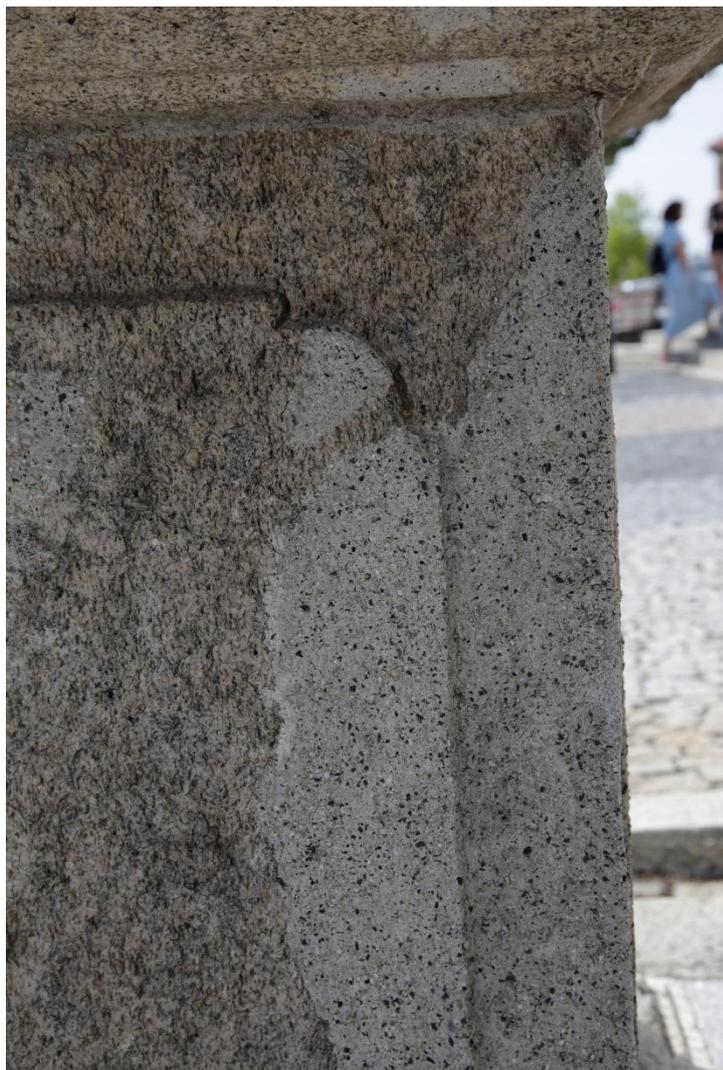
stav před restaurováním pískovcový sokl, detail stavu povrchu
